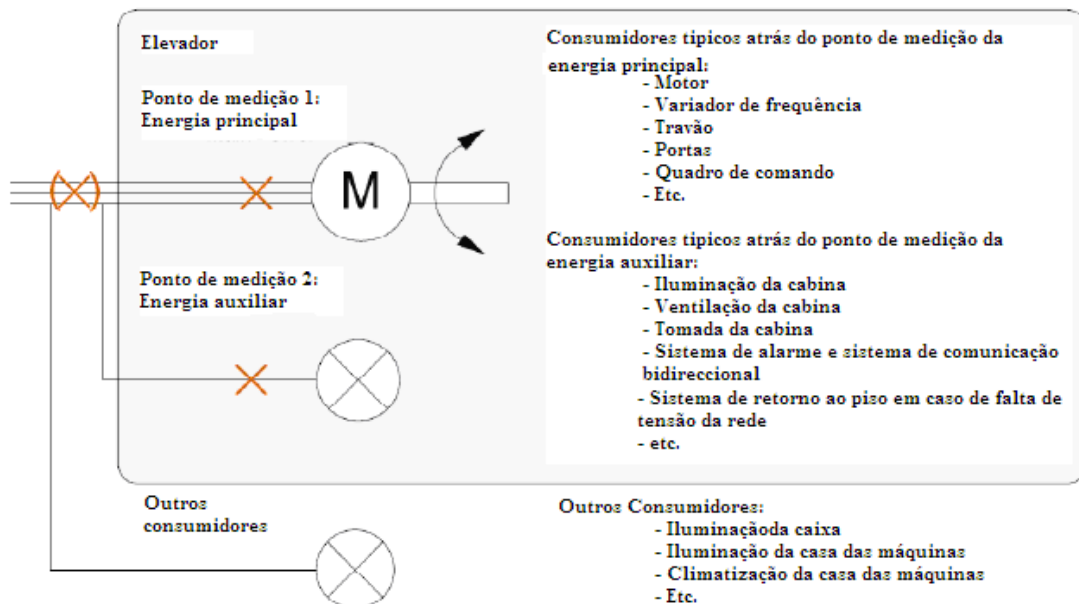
Instalação do elevador e pontos de medição (marcados a laranja) [36]
